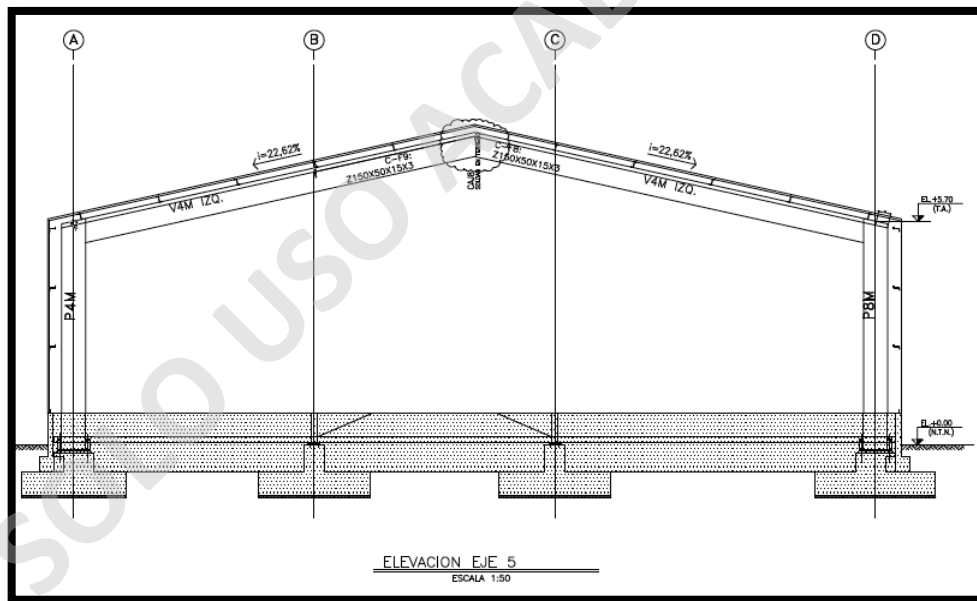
Planos de Montaje ODR Ingeniería y Montajes
